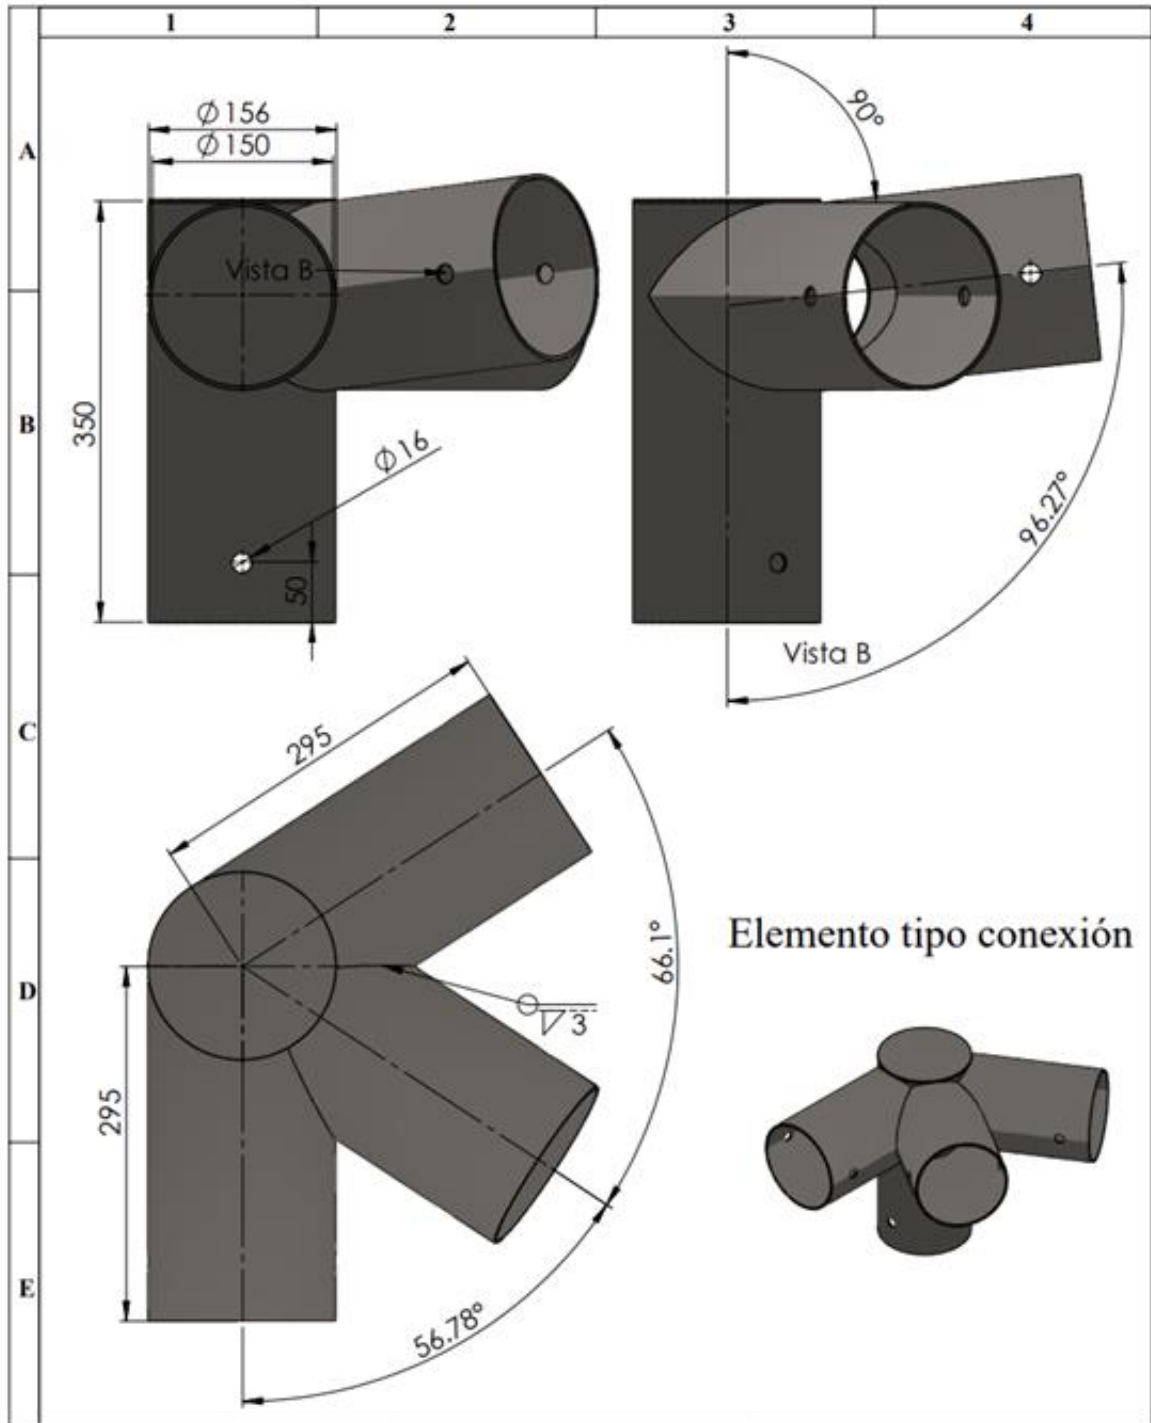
Anexo 1. Detalle estructural de la conexión tipo para propuesta rectangular.
